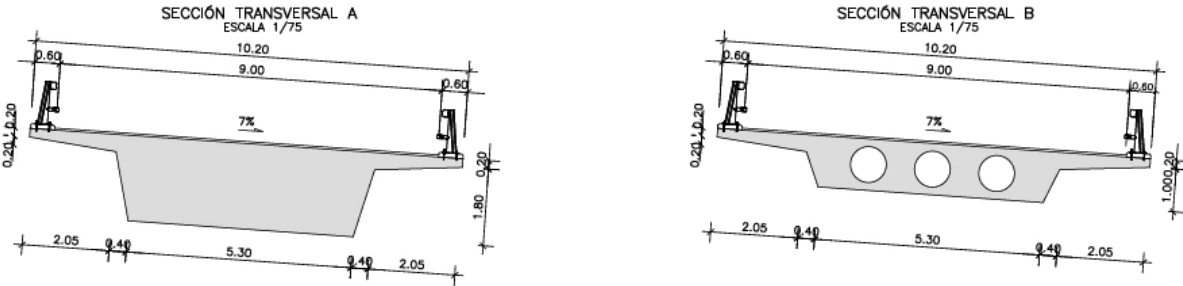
Sección tipo P.S. 9.7 (por centro de vano y por pilas)
